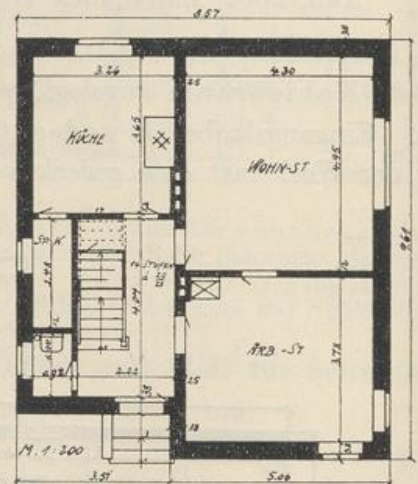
Beamtenwohnhaus. Arbeitszimmer durch Risalit vergrößert. Alle Zimmer vom Flur zugänglich. 2 Schornsteinkasten.
